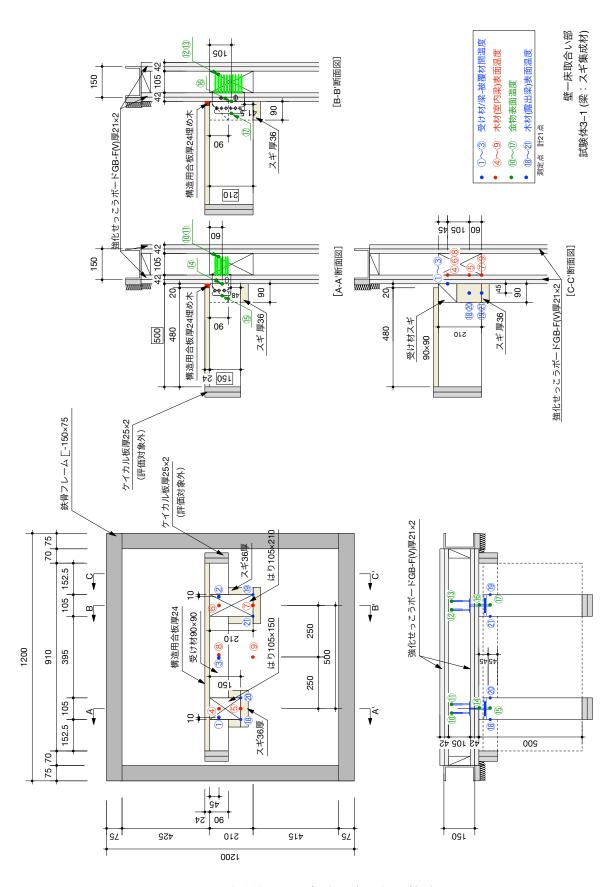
試験体 3-1 壁-床取合い部 熱電対図
